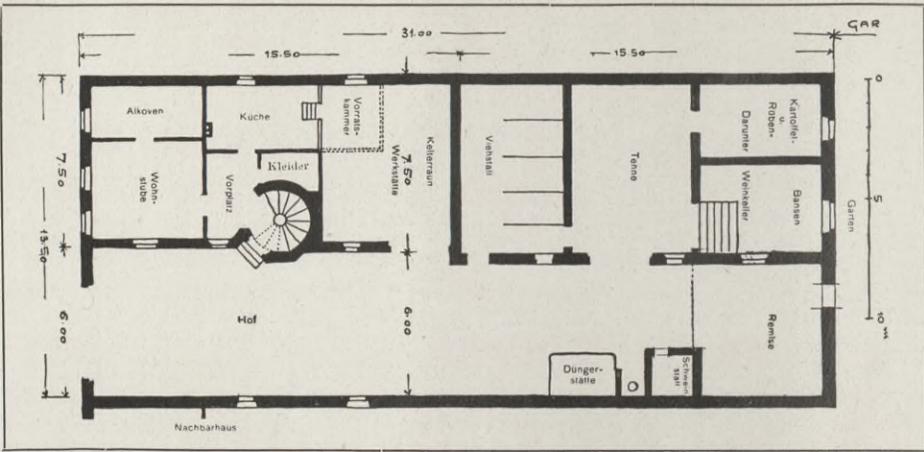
Edenkoben (Vorderpalz) Erdgeschoßgrundriß¹⁾
